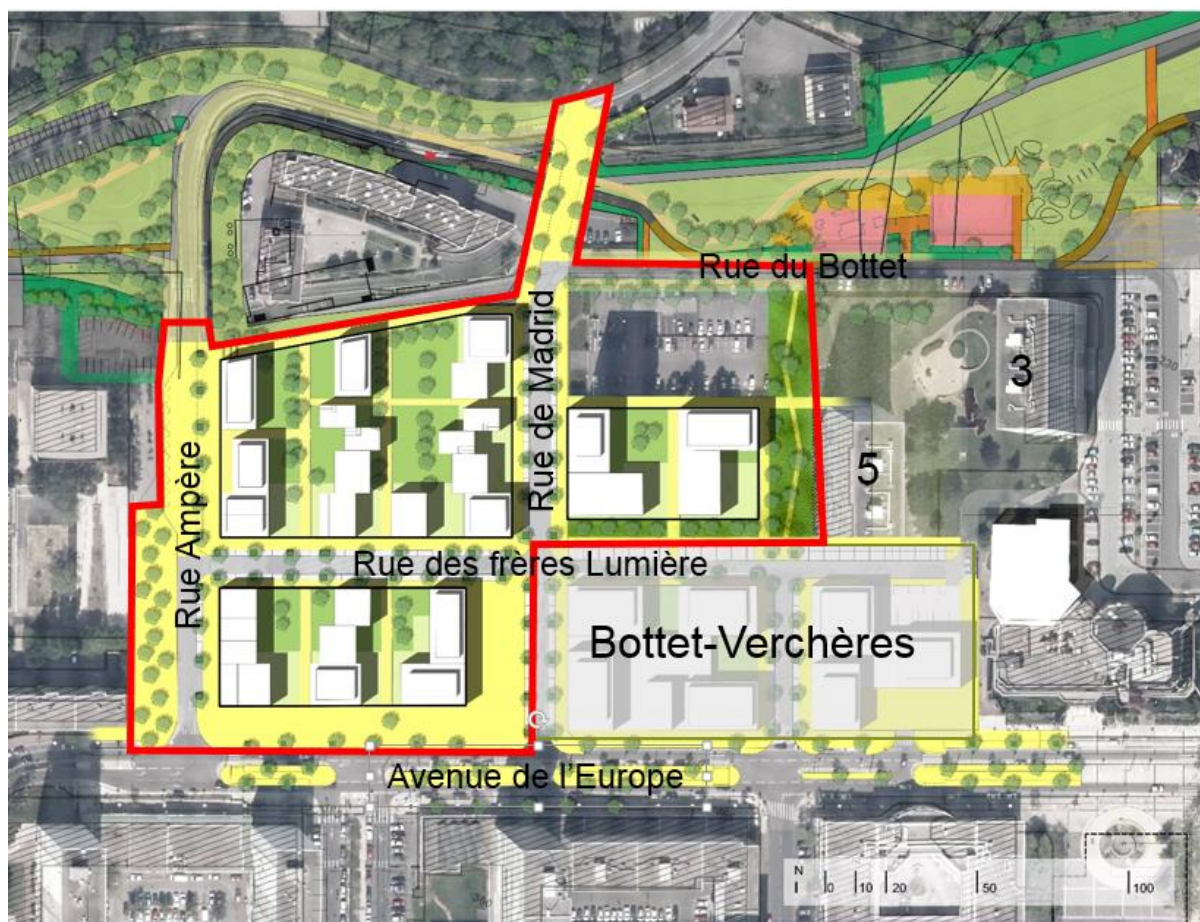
Plan de composition urbaine retenu au stade des faisabilités
